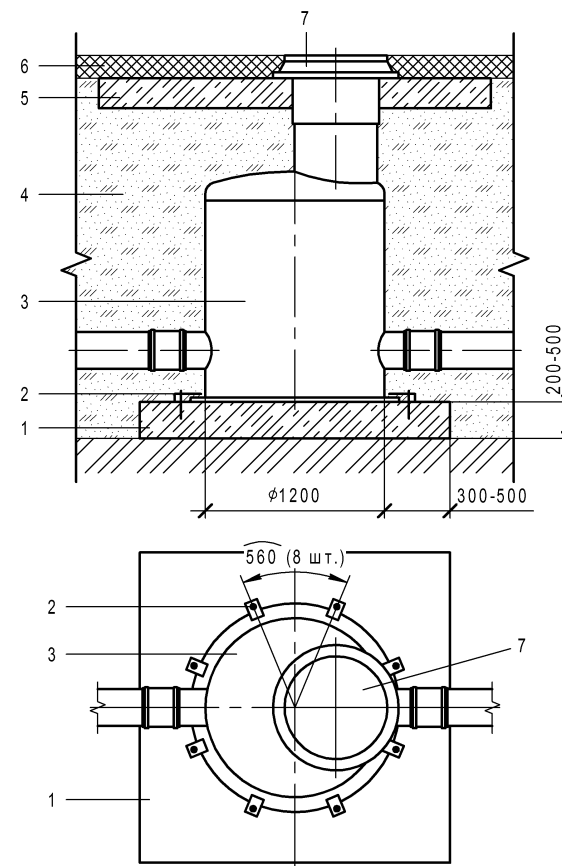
Монтаж блоков ПН, СМ установки «Векса-160-А» на железобетонную плиту под проезжую часть
